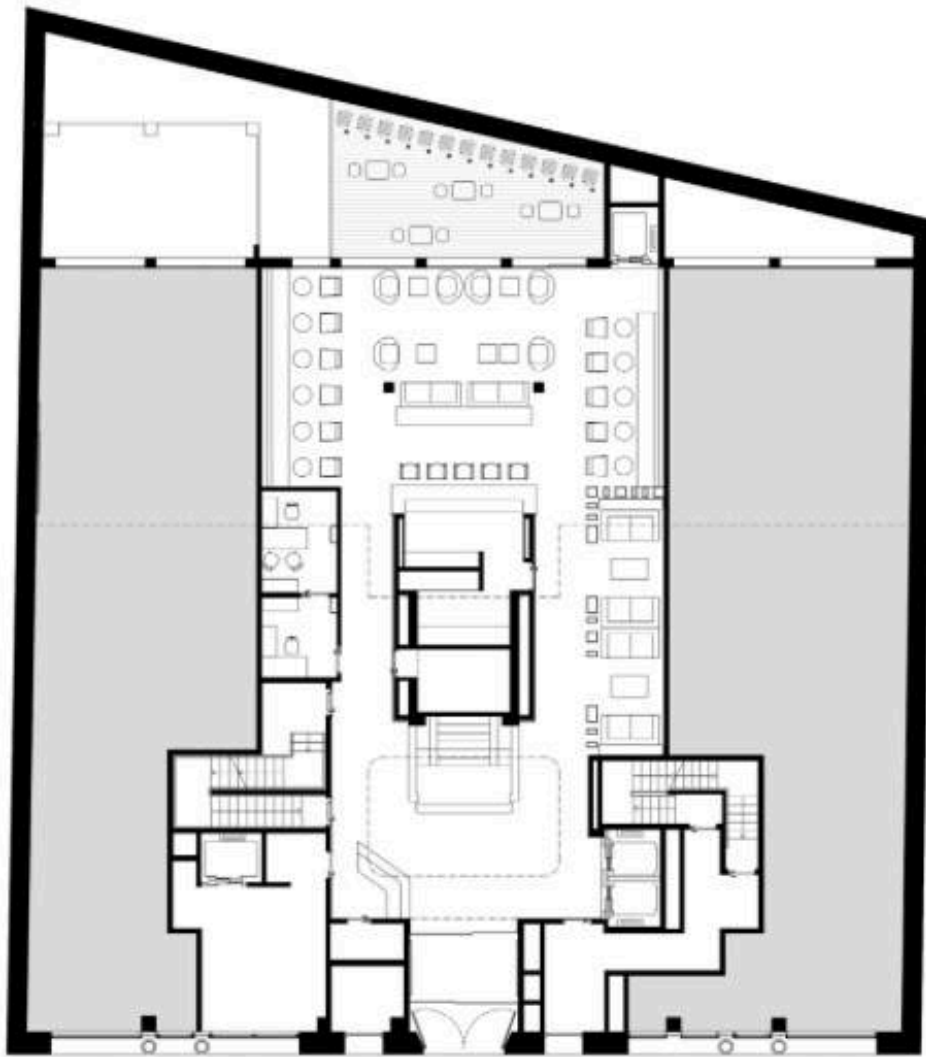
Planta do piso térreo do Hotel Vincci Gala, sem escala nem Norte
